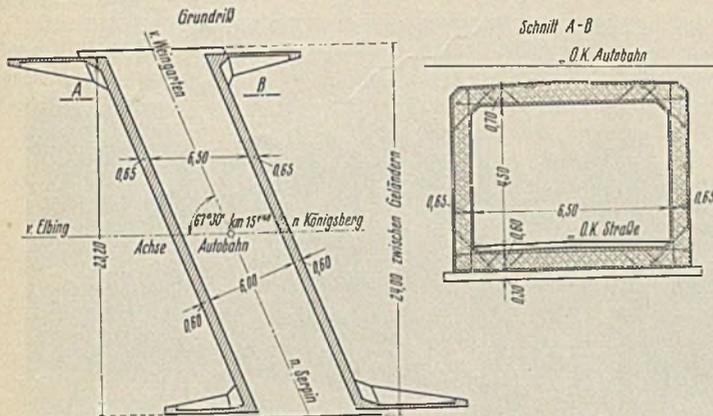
Bauwerk 11, Wegunterführung in km 15,0 + 48, Grundriß und Querschnitt.
